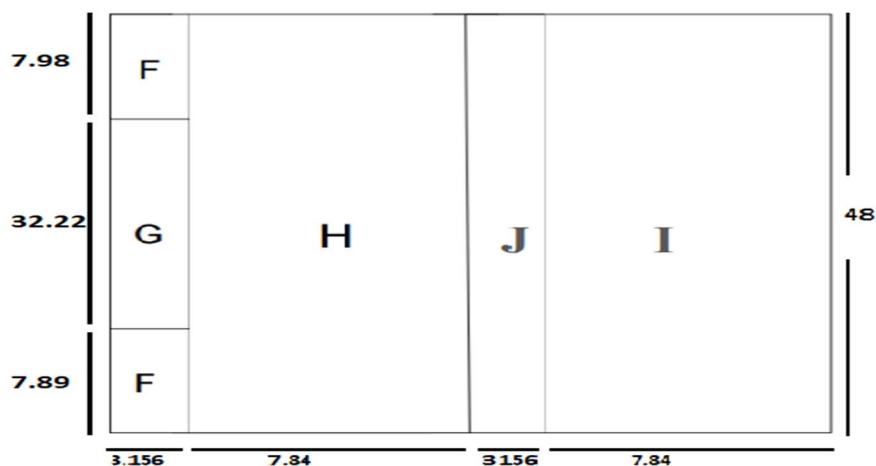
vue en plan des zones de pression sur la toiture suivant V2
